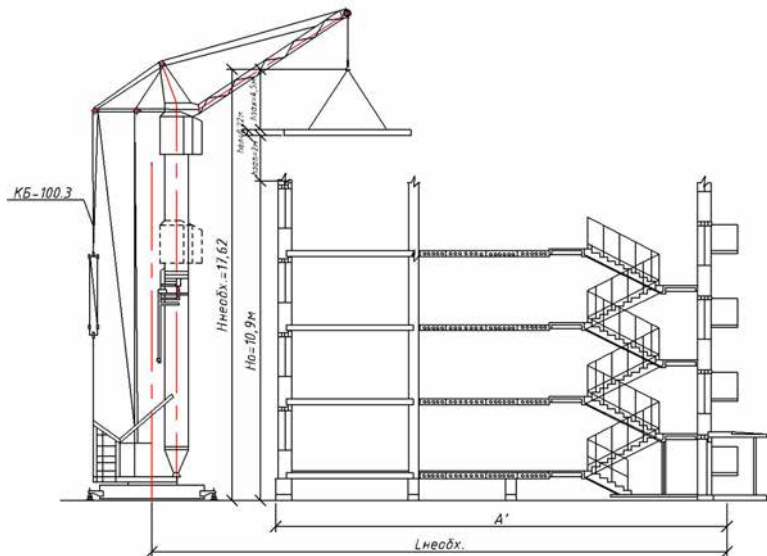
Схема монтажу плит перекриття будівельним краном
